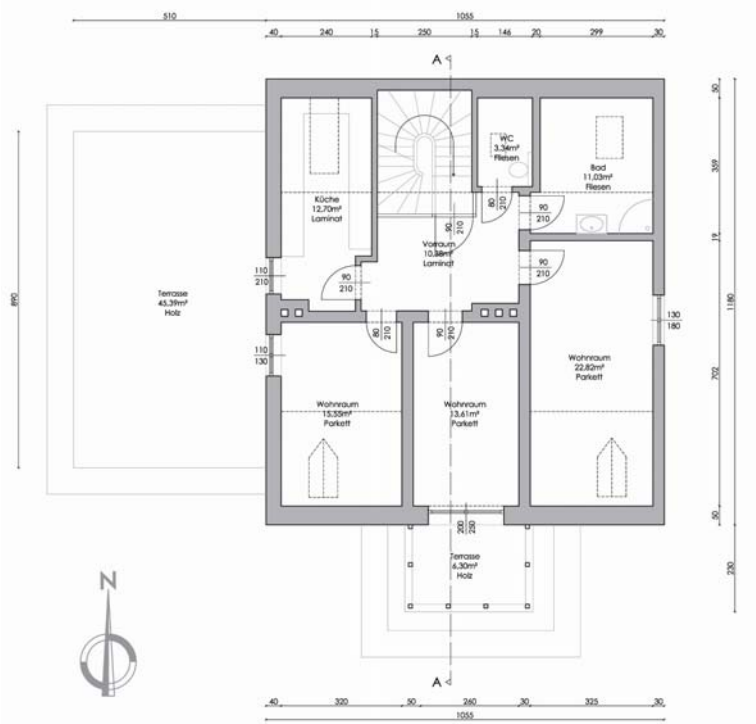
Modell EFH – Grundriss Dachgeschoß 1:200
